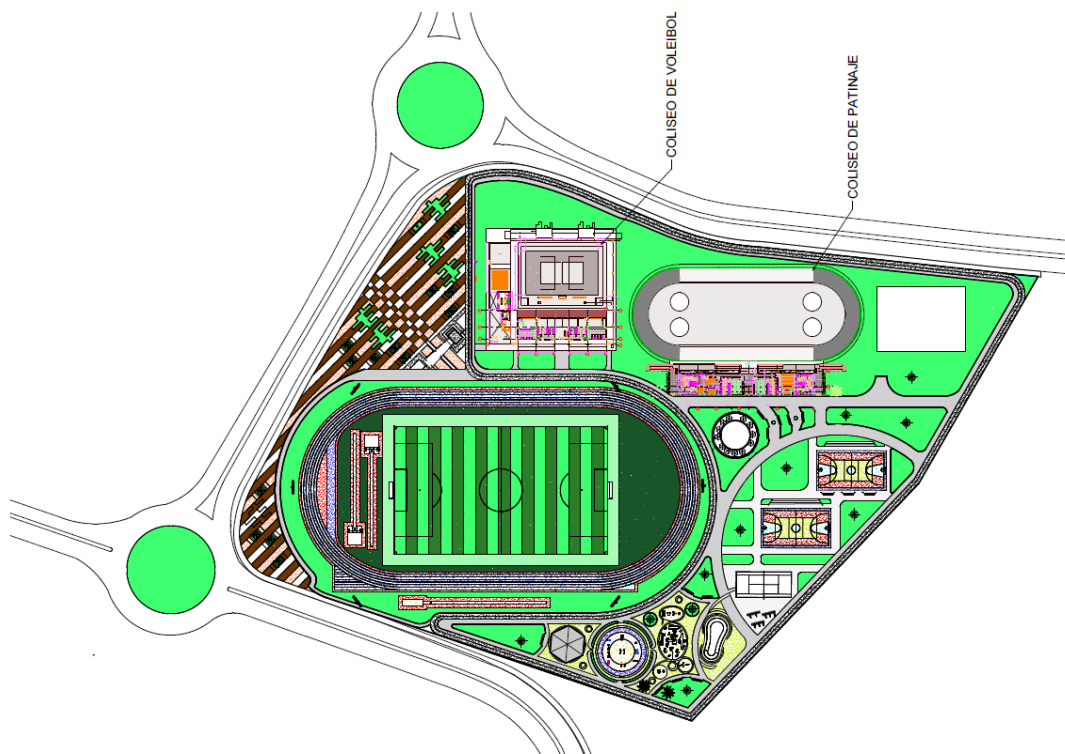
Ubicación estructuras a construir Complejo deportivo Leticia
